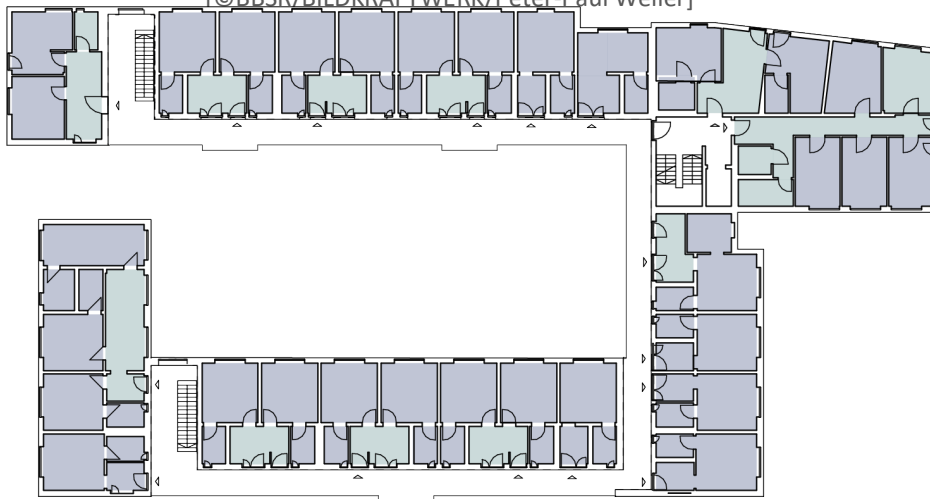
Laubengänge als kommunikative Zone sowie Erweiterung der Wohnraums, Grundriss Regelgeschoss, Jena, M 1:500. [©DGJ Architektur GmbH]
